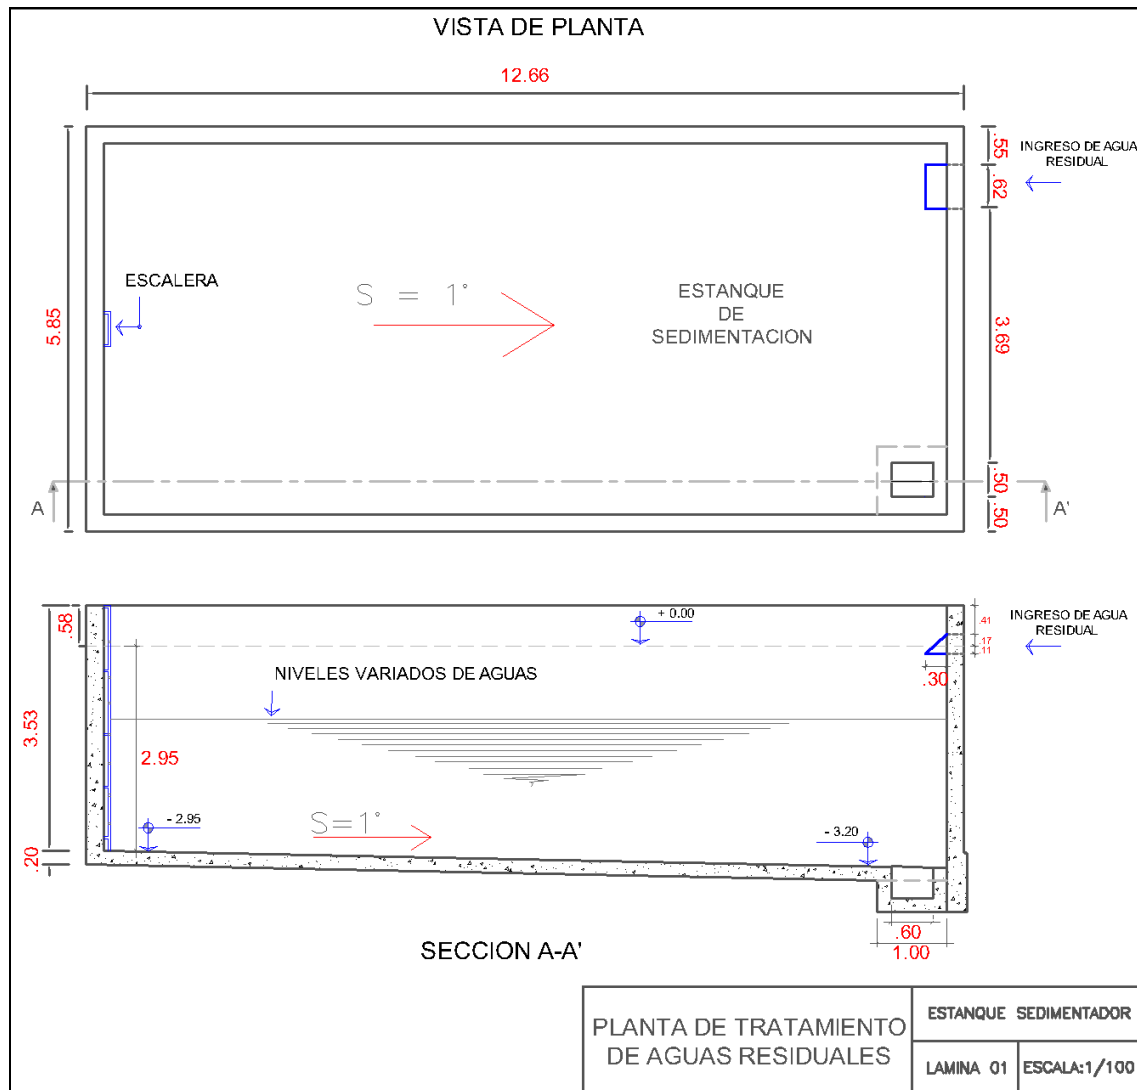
Vistas de planta y sección A-A' del estanque de sedimentación.
